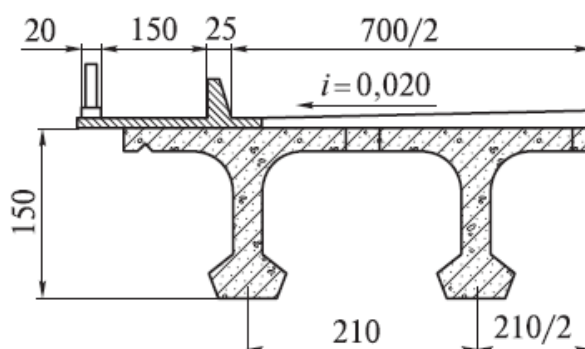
Компонировка поперечного сечения сборных ребристых пролетных строений с напрягаемой арматурой
